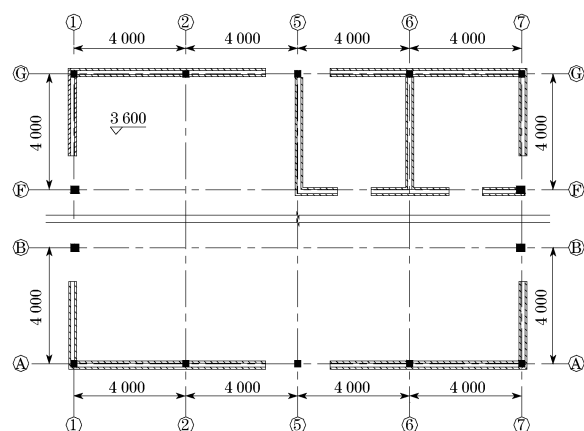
餐厅二层剪力墙平面布置图(单位:mm)
